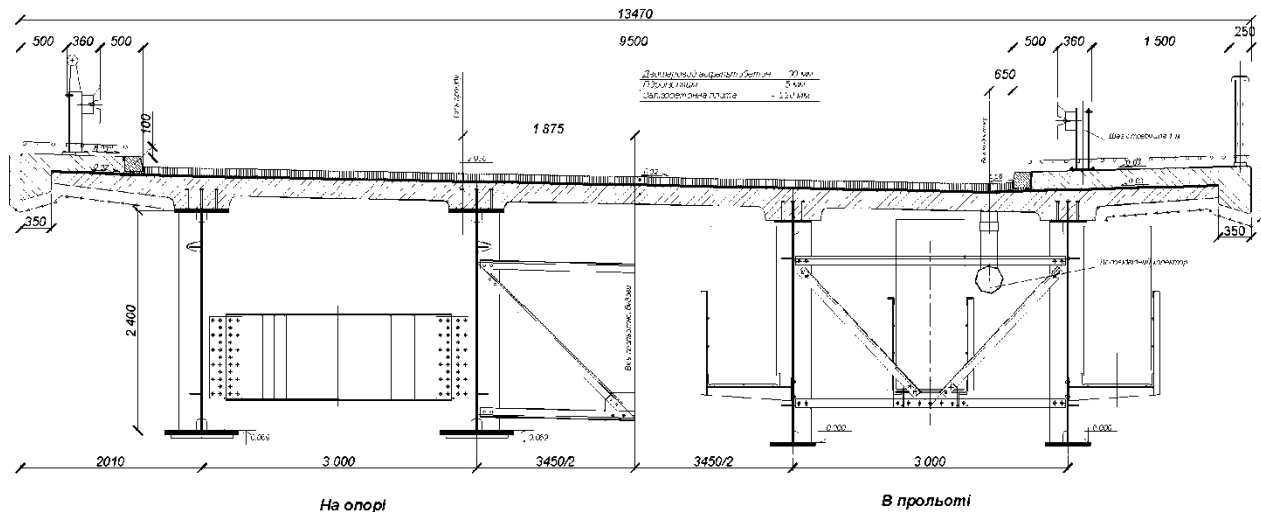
Поперечний переріз сталезалізобетонного моста через р. Західний Буг
